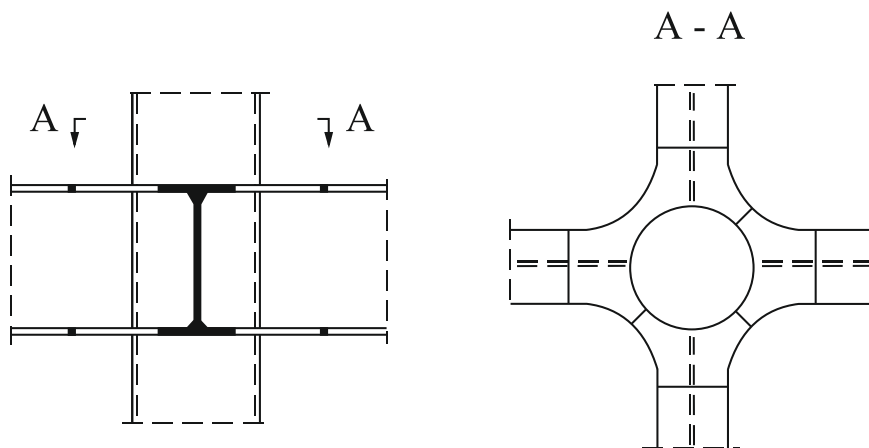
Сопряжение ригелей двутаврового сечения с трубобетонной колонной круглого сечения [4]
